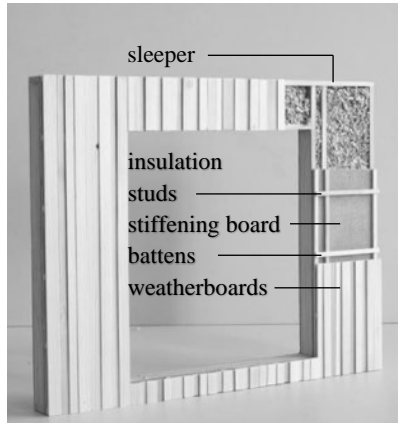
Design Konzept für Fassadenelement, Model: M. 1:20
